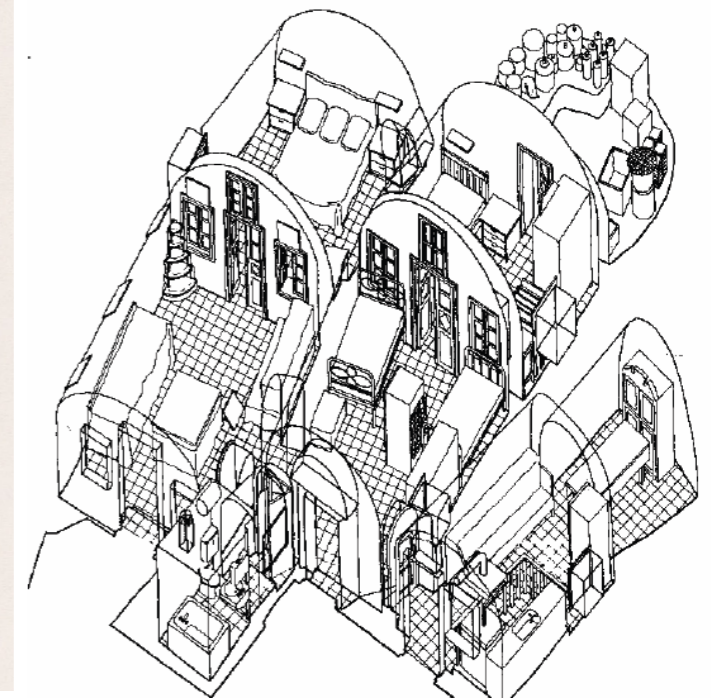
Esquema de las construcciones de Oia⁷⁹.
